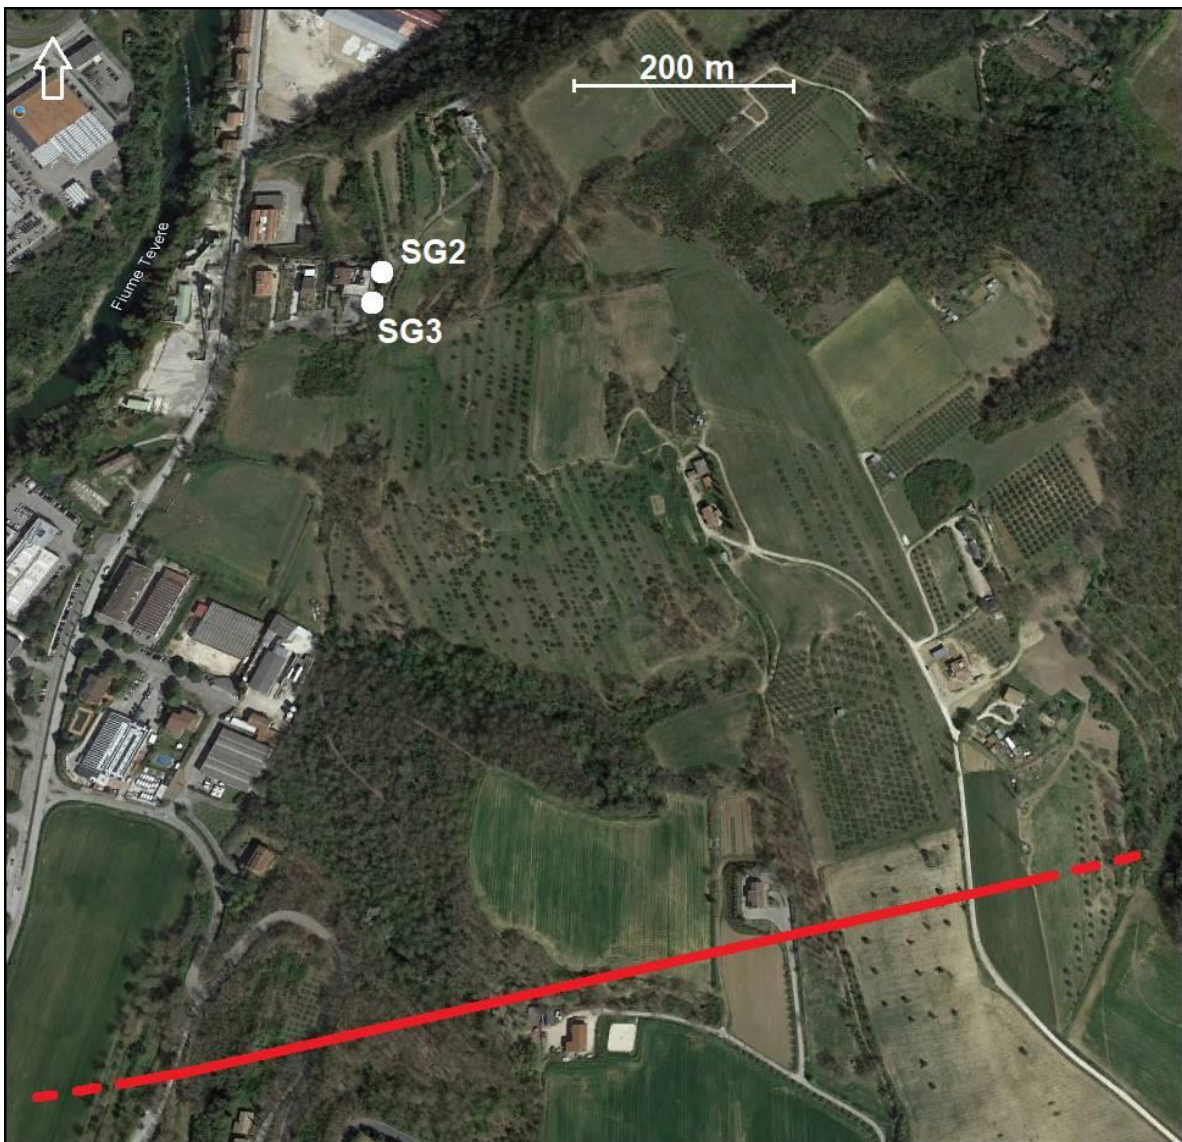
Ubicazione in pianta delle stazioni geomeccaniche lungo il tracciato in progetto (immagine satellitare da Google Earth). In rosso: tracciato della galleria.
